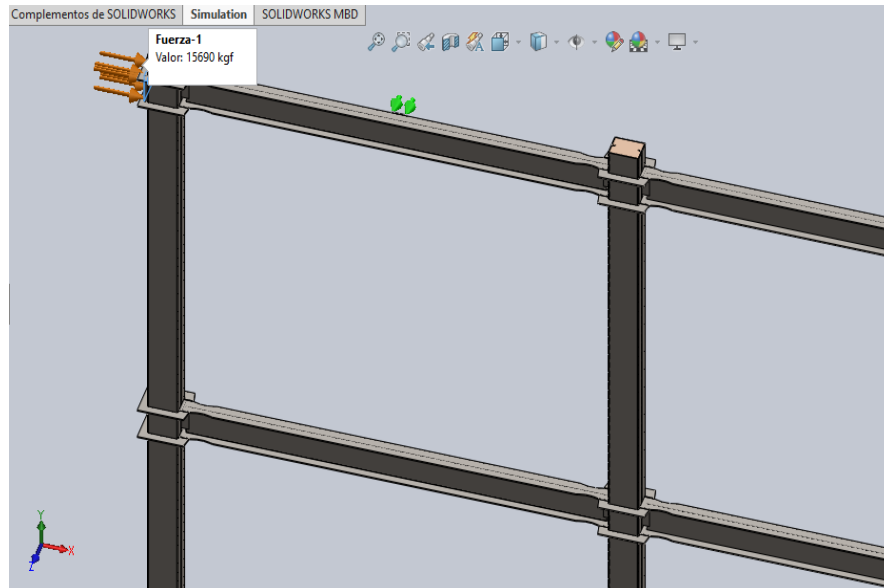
Mallado de elementos finitos pórtico 3 con reforzamiento trapezoidal
